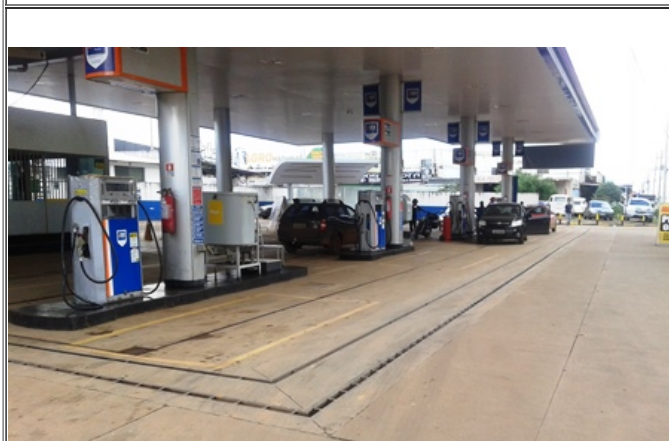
Canaletas de SDO (interior) e de drenagem pluvial (externo).
